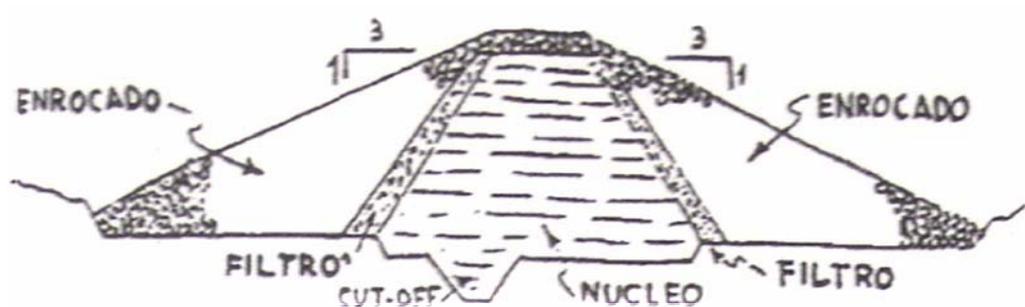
Presa heterogénea con núcleo ancho [3]
